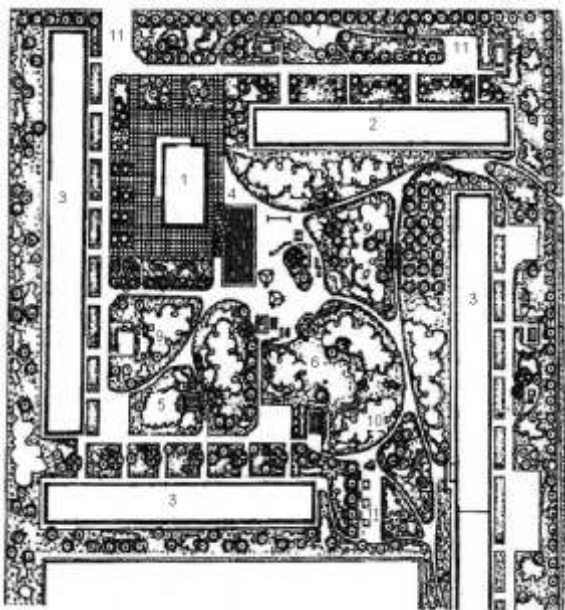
Пример озеленения и благоустройства двора-сада жилой группы: 1 – пункт первичного обслуживания; 2 – 9-этажный жилой дом; 3 – 5-этажный жилой дом; 4 – бассейн; 5 – детская площадка; 6 – площадка для сушки белья; 7 – площадка для отдыха; 8 – теневой навес; 9 – пергола; 10 – площадка для настольного тенниса; 11 – разворотная площадка
